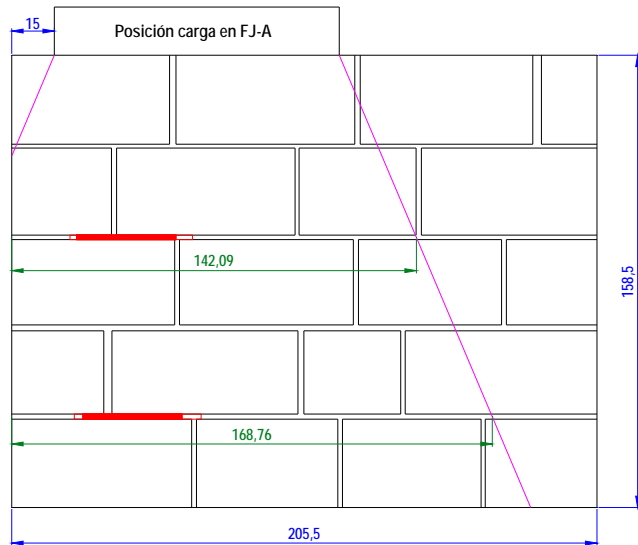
Ubicación de los ensayos de gato plano simple (corresponde al emplazamiento superior) y doble GPS-A en el alzado del muro de la sillería. Las cotas relacionadas están en cm.
